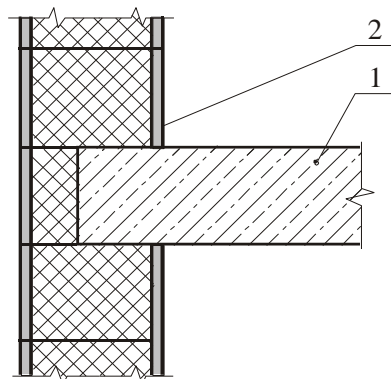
Конструкция стенового ограждения многоэтажного жилого здания с использованием
